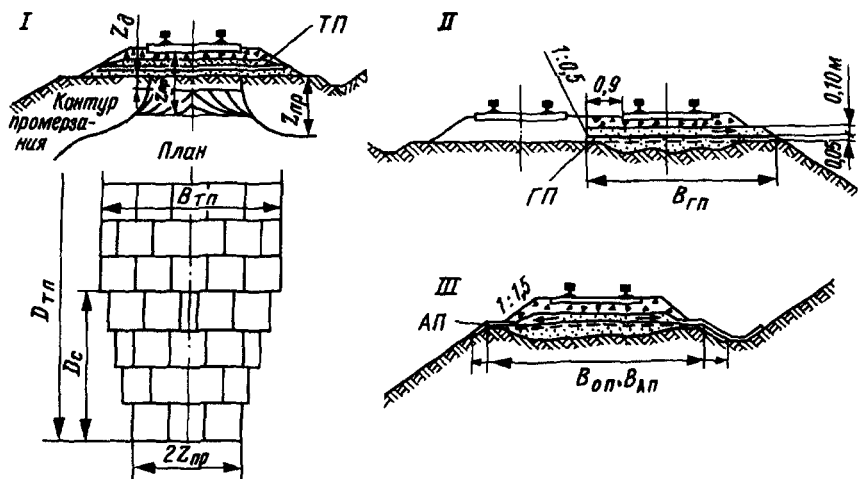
Схемы покрытий для оздоровления ОП: I — термоизолирующее покрытие; II — гидроизолирующее покрытие (под один путь); III — армирующее покрытие (из геотекстиля)
